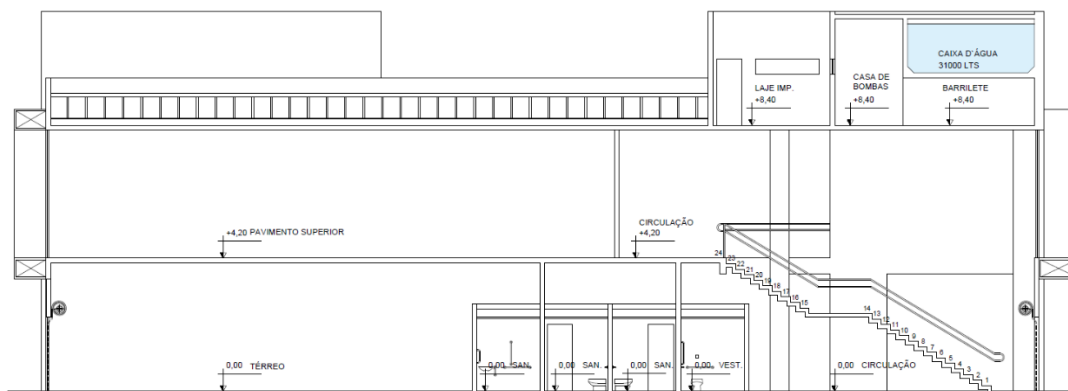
Corte AA da planta de arquitetura. (RR Roberto Arquitetura, modificada)
